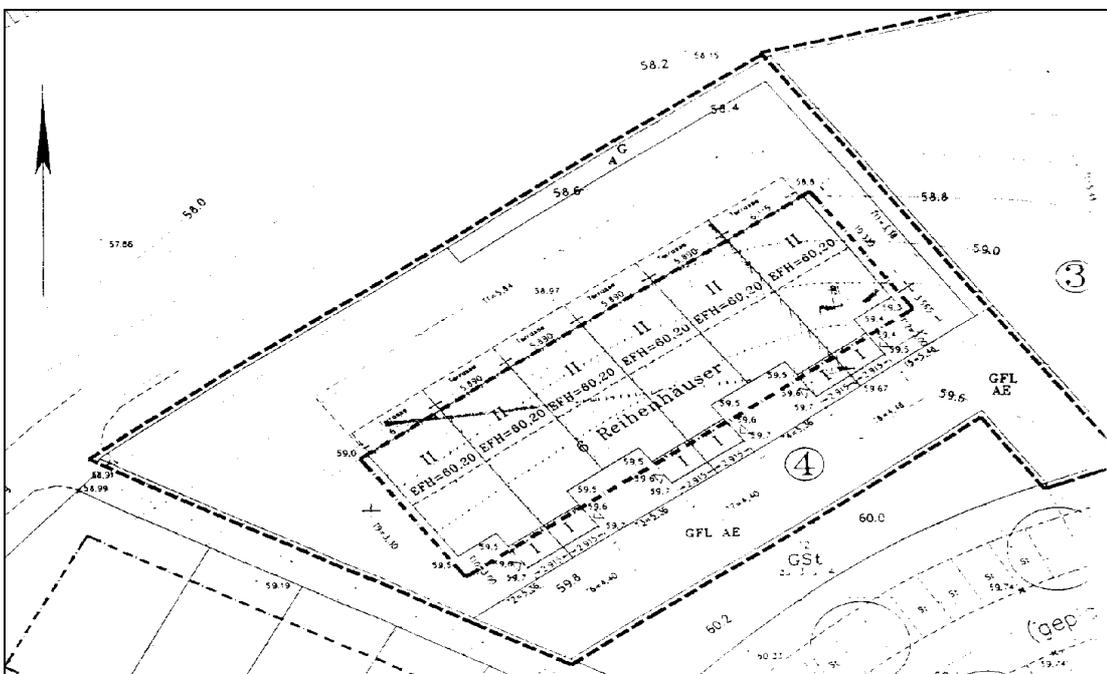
Lageplan des Projektes „Münster - Mecklenbeck“ [19]
